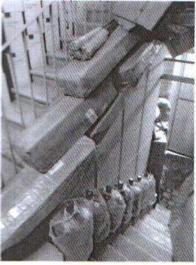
, 17. Фрагменты лестницы, северо-западная часть здания. Фото 18. Фрагмент лестничной площадки в северо-восточной части здания
